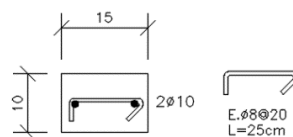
Detalle constructivo de pilarejos – Fuente: Ponce, n.d.
